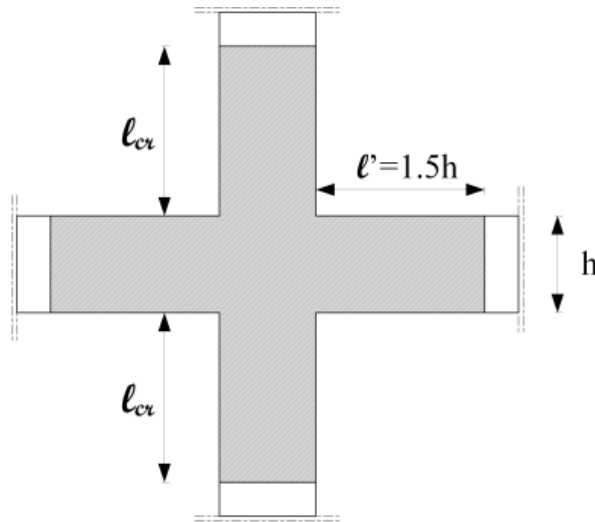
Détails d'armatures longitudinales et Détails de zone nodale
